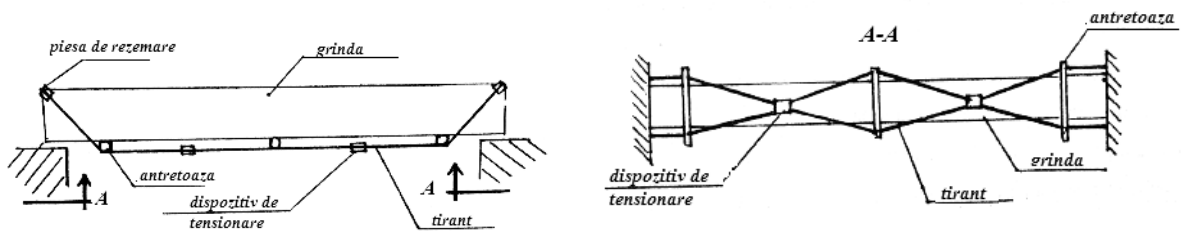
, b Consolidarea grinzilor din beton armat cu tiranți metalici [66]
